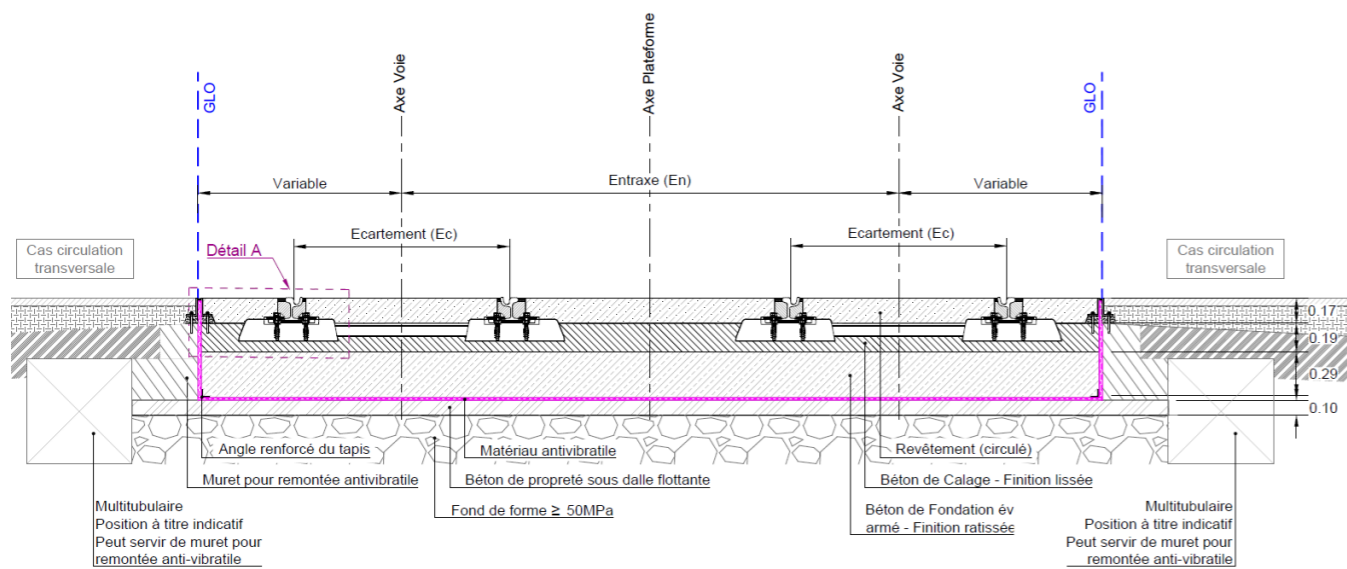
coupe type d'une plateforme - Voie béton traverses - Dalle flottante
